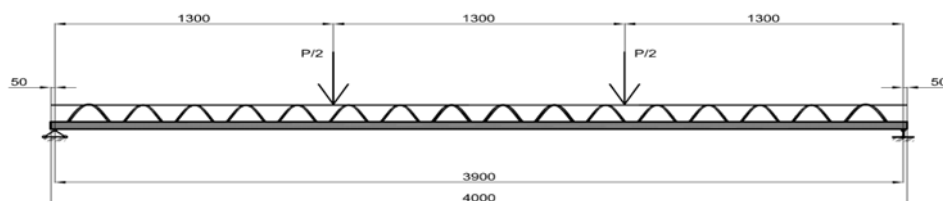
Схема випробування залізобетонних плит незнімної опалубки ПО–4
